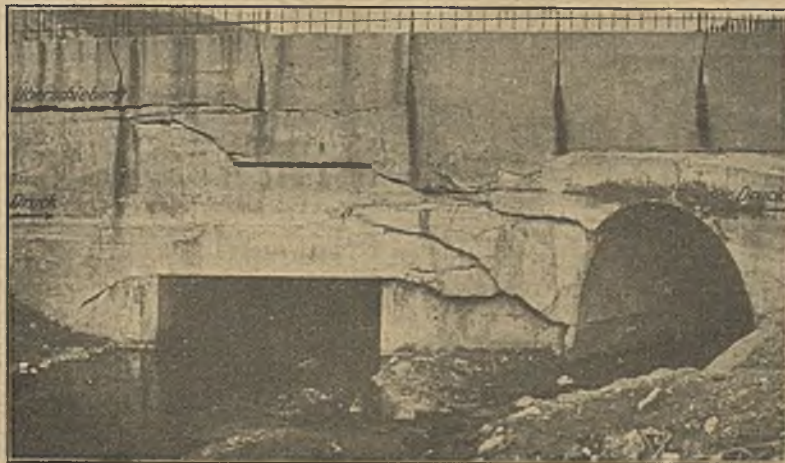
Durch horizontale Pressung beschädigte Betonbrücke.
